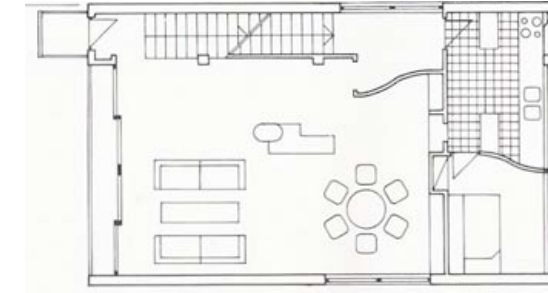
Grundriss 1.OG, Einzelwohnhaus.
